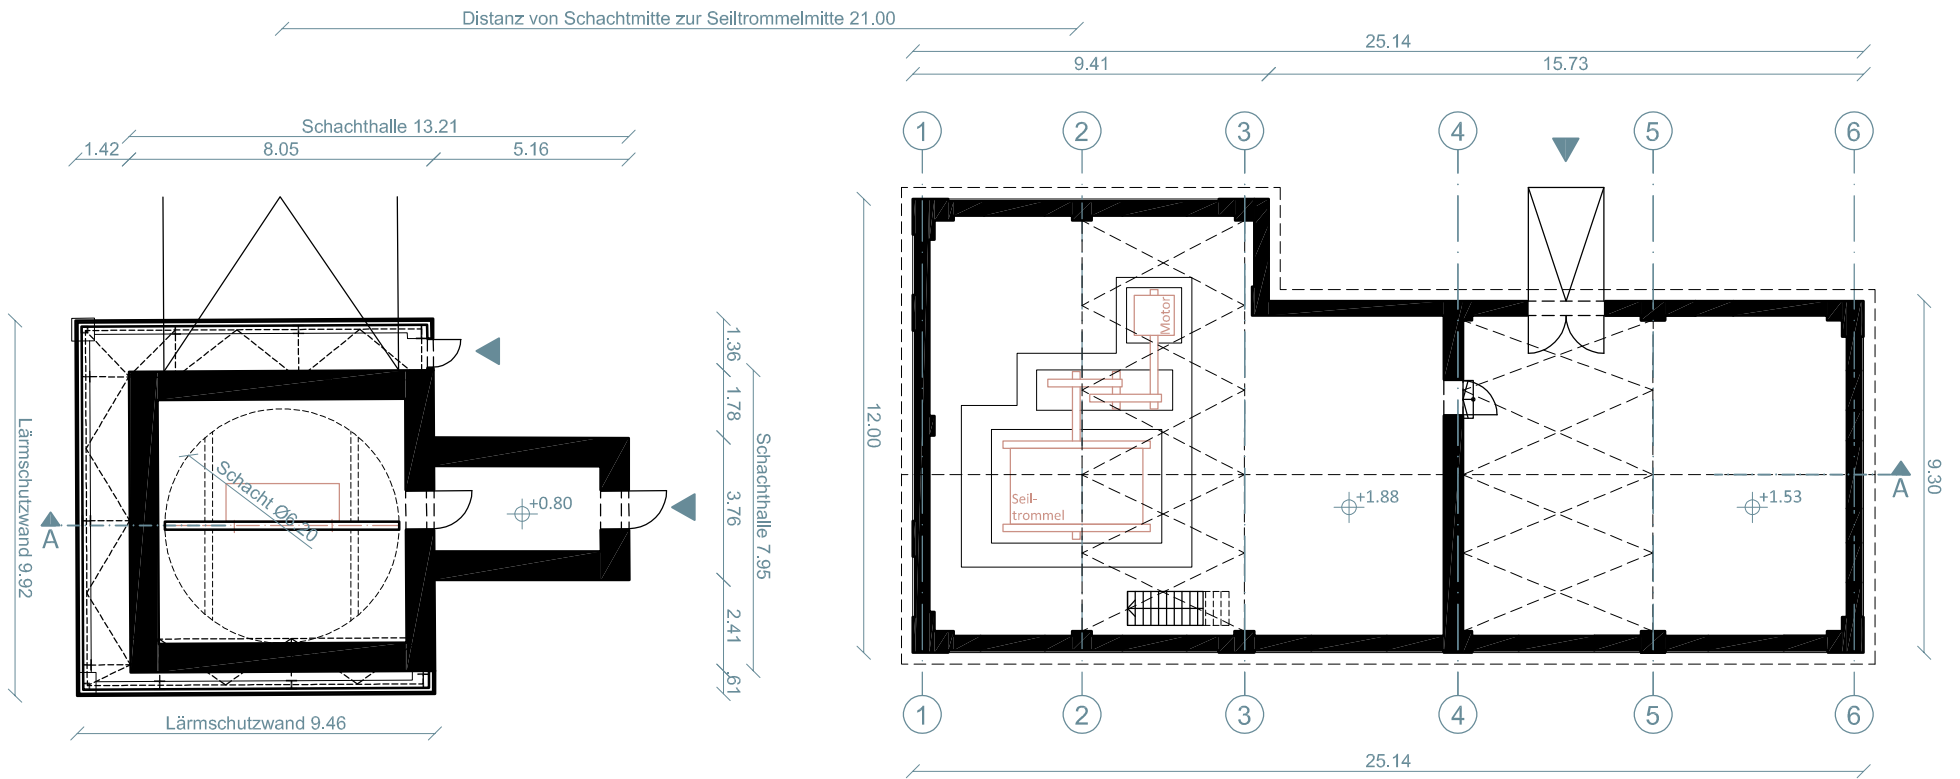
EG, Schachthalle und Fördermaschinenhaus, M 1:200
